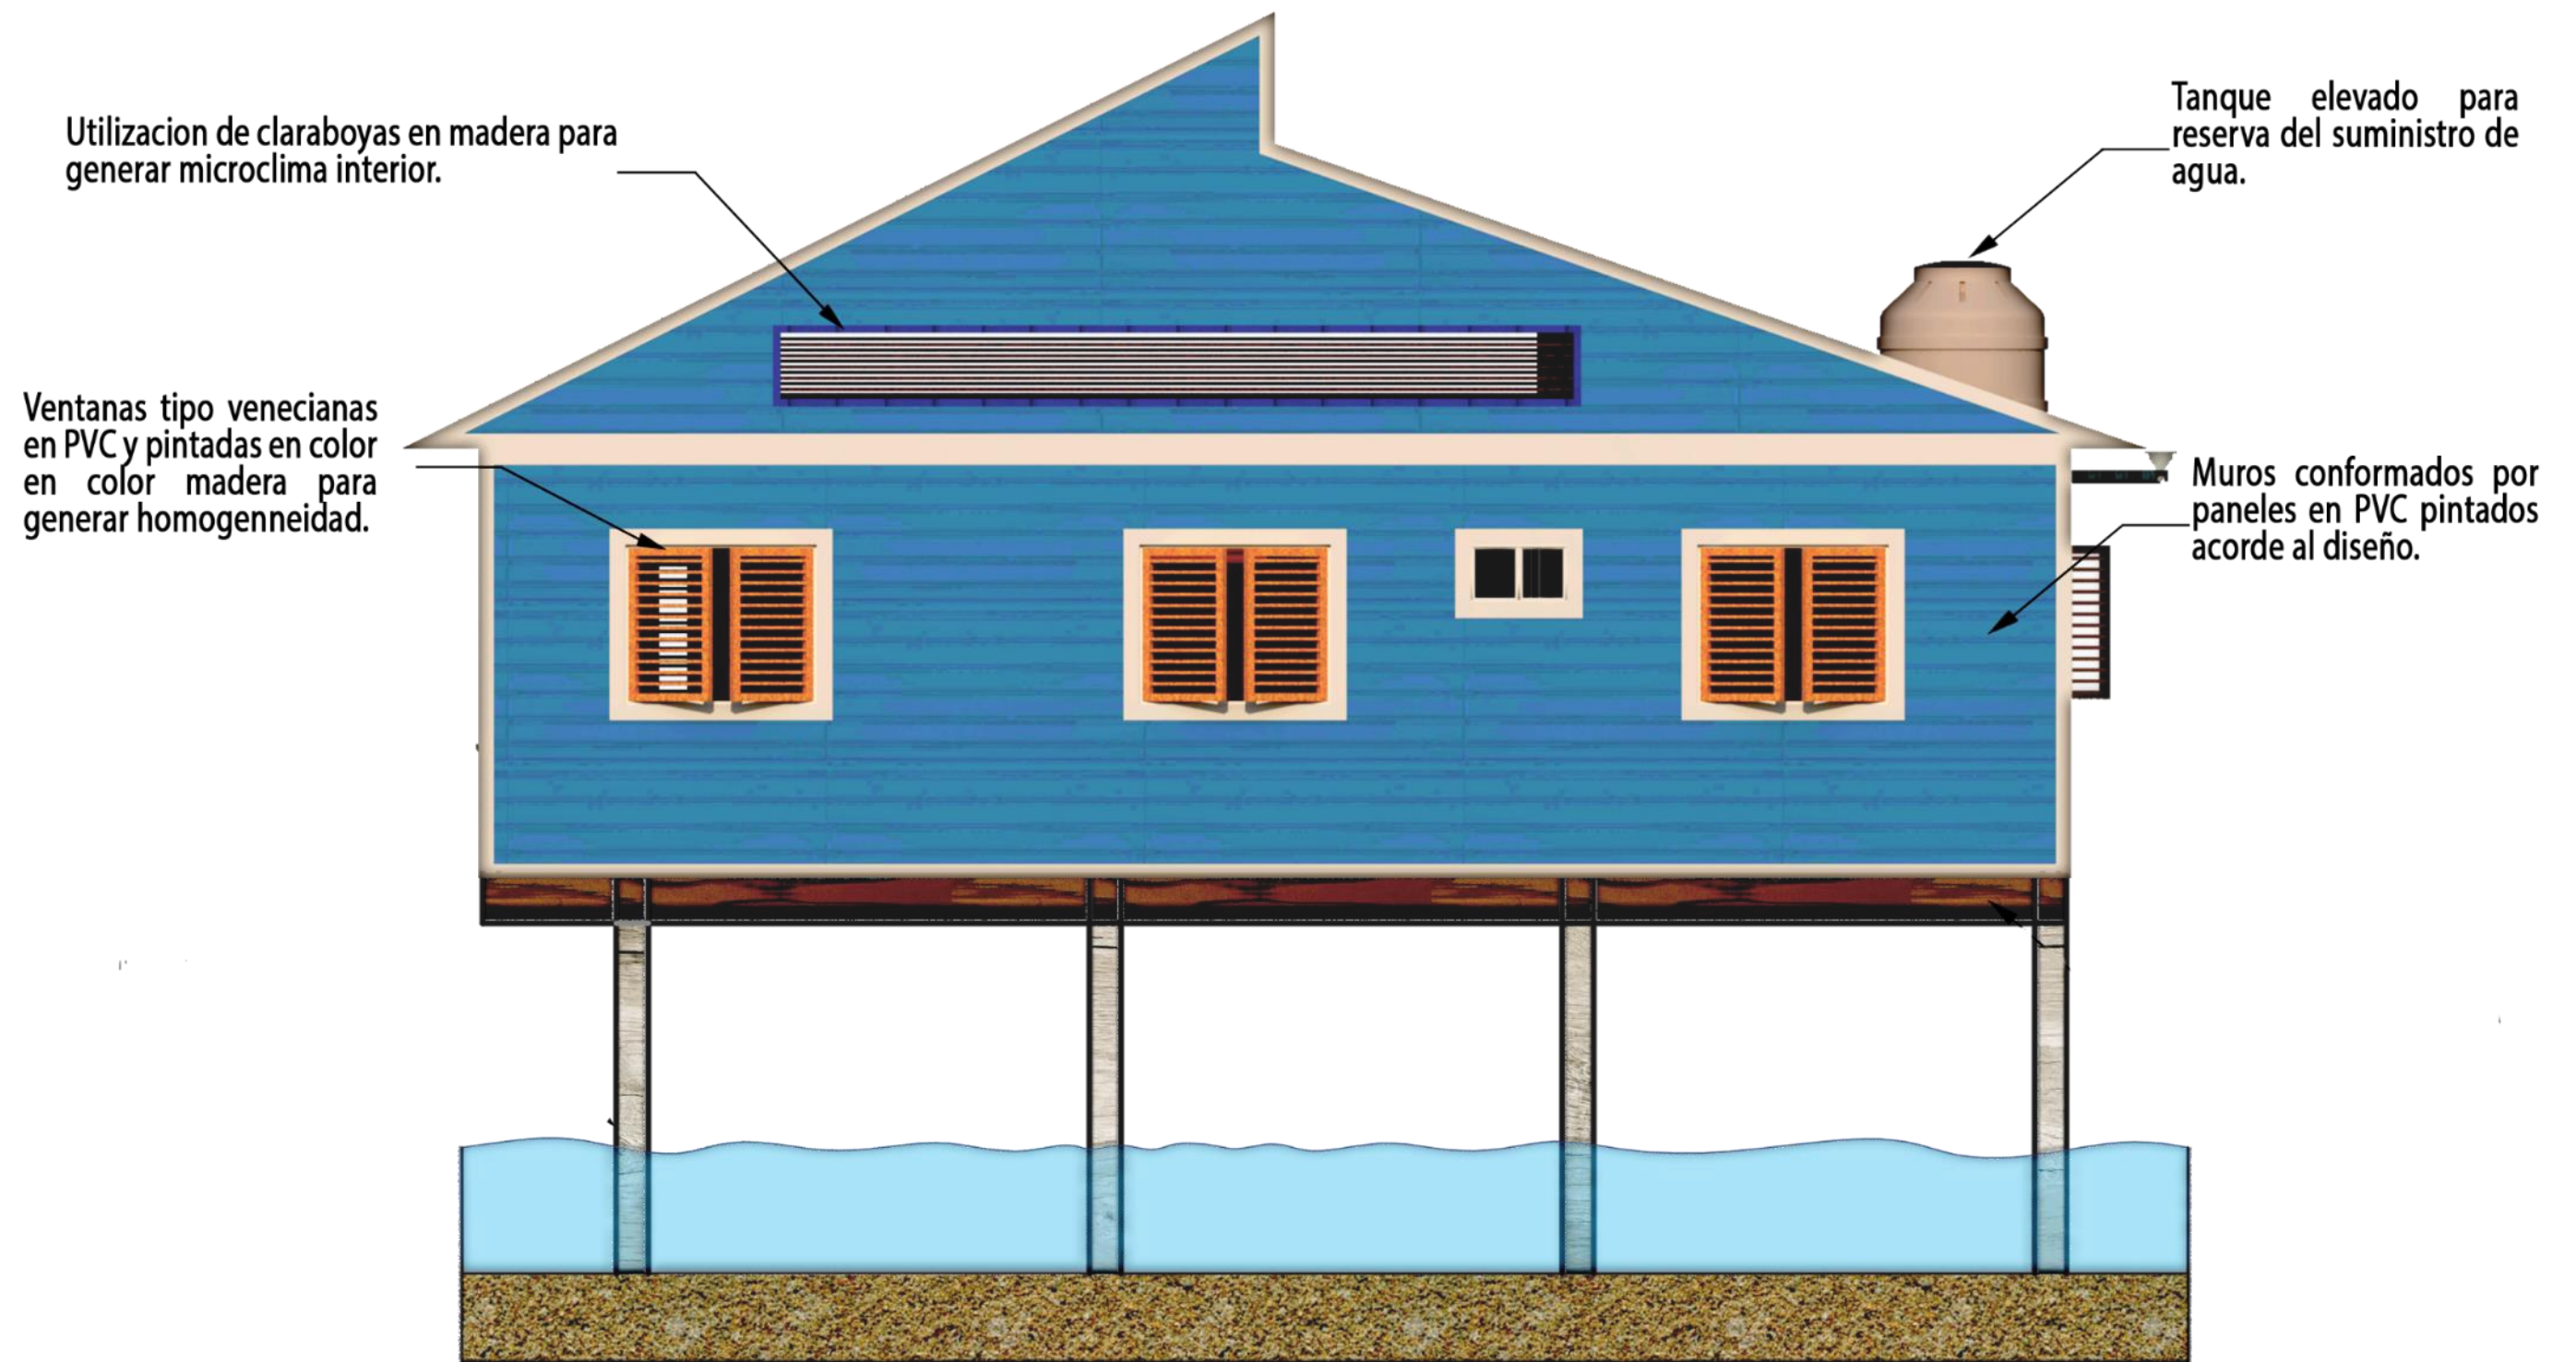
Alzado este vivienda modelo. Fuente: Elaboración propia
